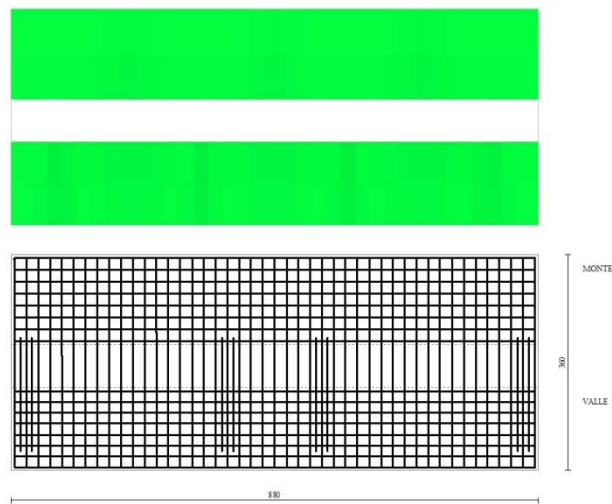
Piastra fondazione dir. X (Inviluppo)
